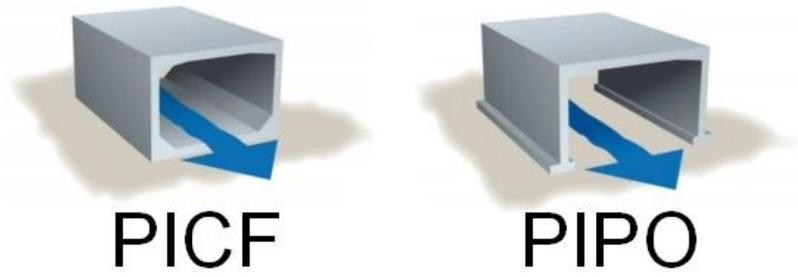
Différence entre les ouvrages de type PICF et PIPO – Onema, 2014.
